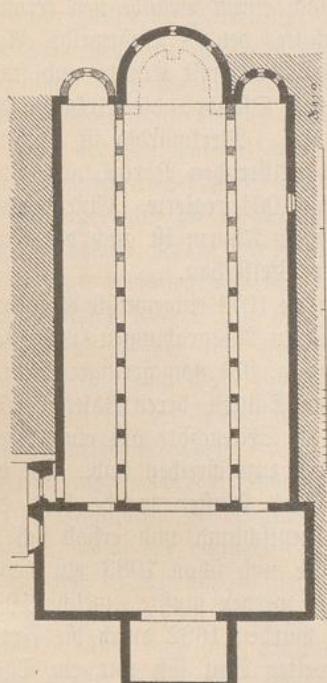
St. Emmeram zu Regensburg. Grundriss.
